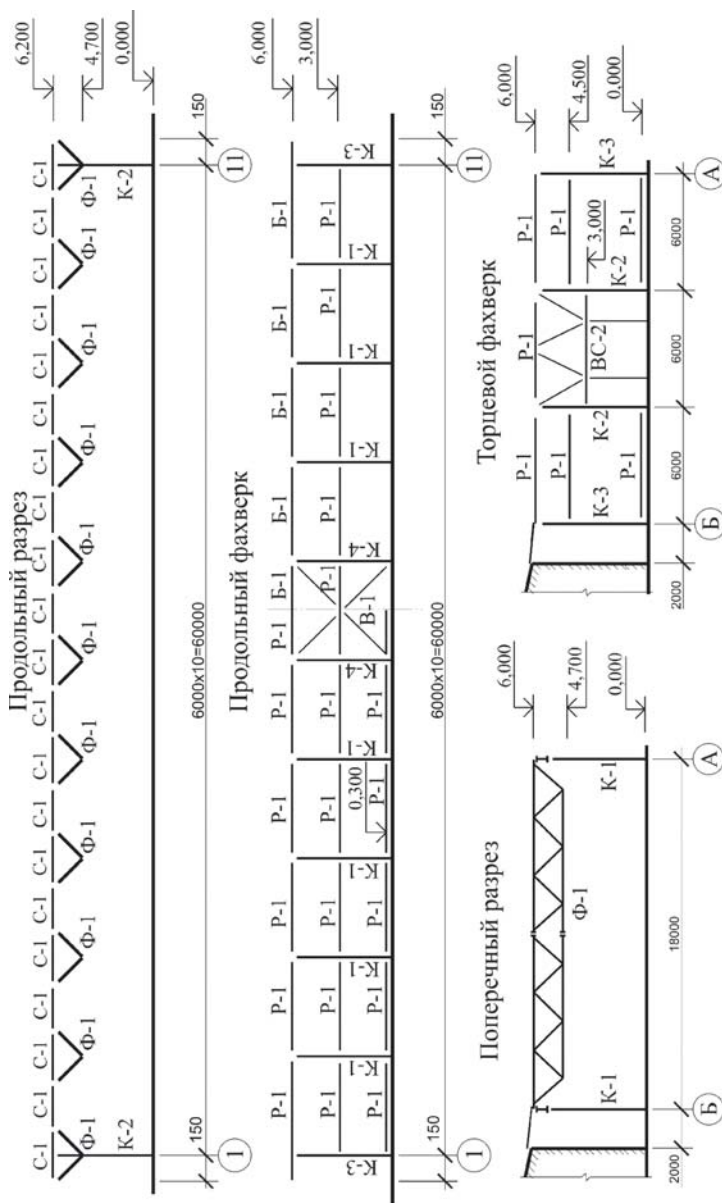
Разрезы по каркасу (покрытие с фермами пролетом 18 м)
